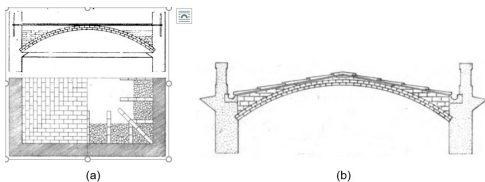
Aplicação da abobadilha alentejana (planta e cortes): (a) como pavimento; (b) como cobertura (Derand 1802)
